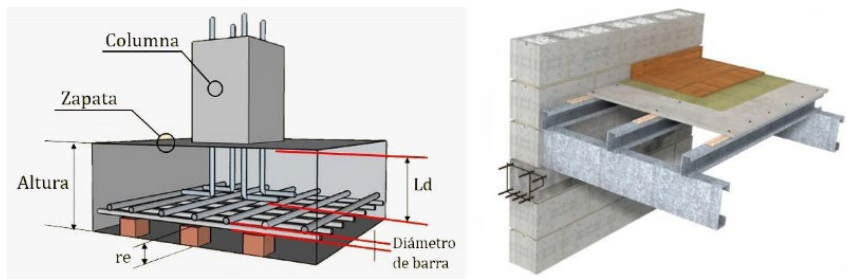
Zapata aislada: Dimensiones de zapatas perimetrales y esquineras figura 70: detalle entre piso losa con viguetas:
